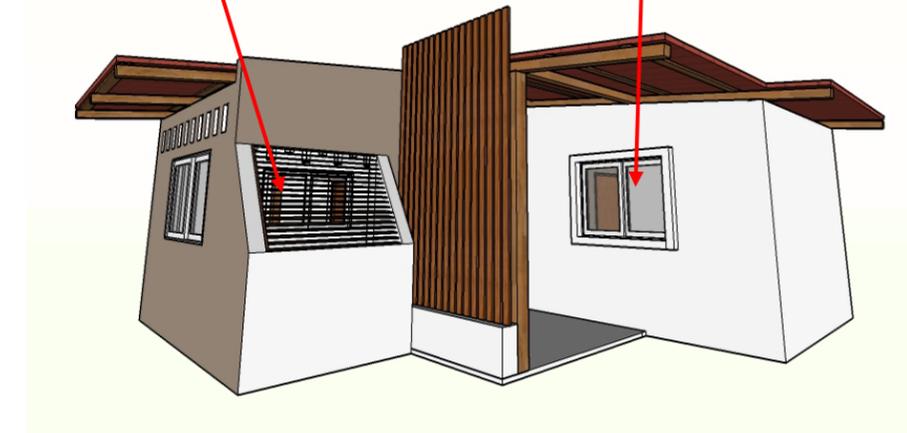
Elevación 1 de propuesta de vivienda bioclimática con elementos de identidad. Fuente: equipo de trabajo
